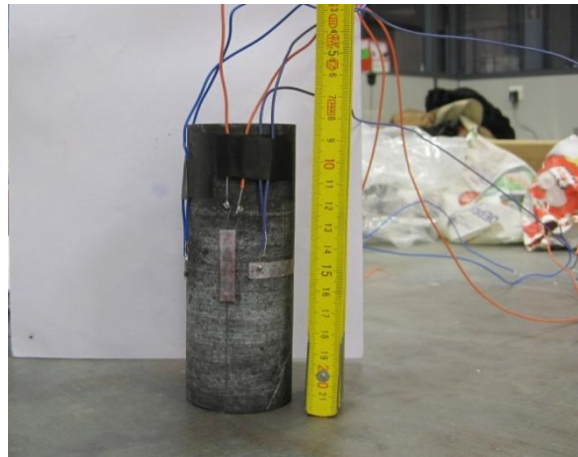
Disposição da colagem dos extensómetros nos provetes de RCU
